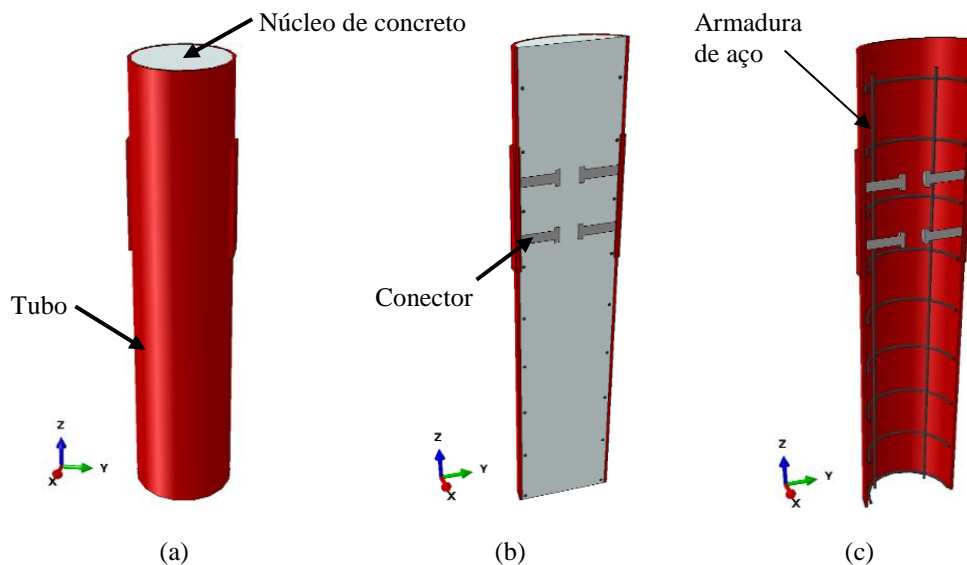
Elementos de PMPC utilizando conectores pinos com cabeça: (a) vista sem corte, (b) vista com corte na direção longitudinal, (c) vista com corte na direção longitudinal antes da concretagem.
